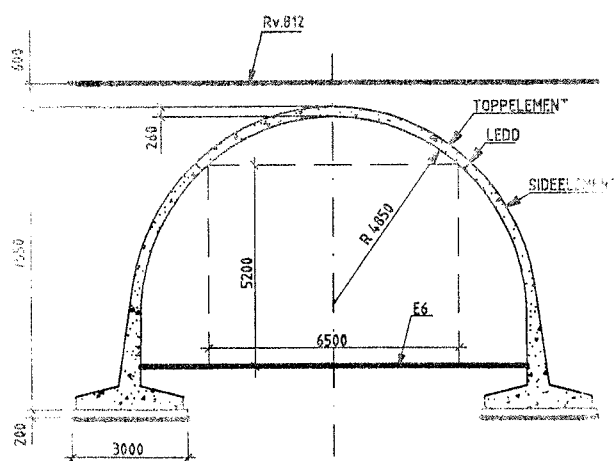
Tverrsnitt av betongelementtunnelen for E6
